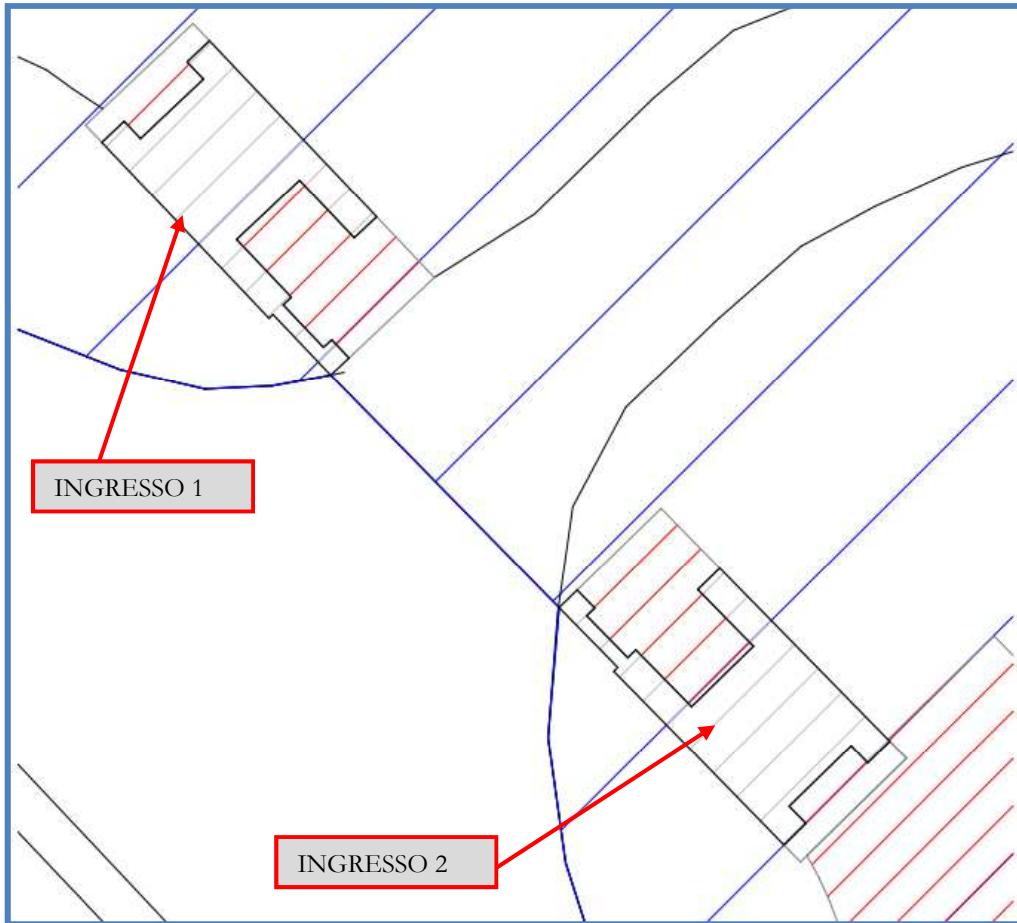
fabbricato ingresso 1 -2 - PLANIMETRIA
